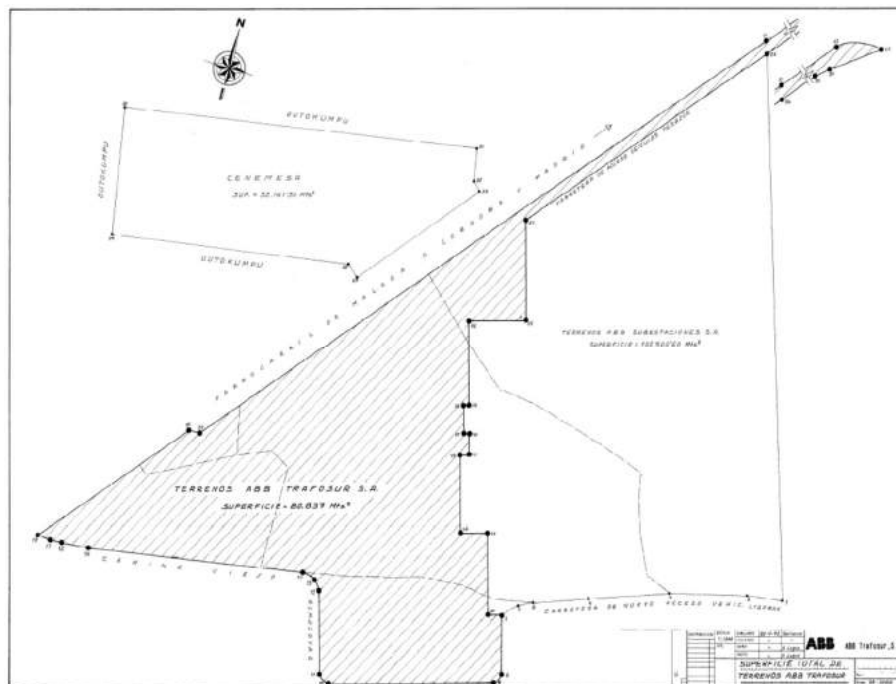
Planos catastral elaboración propiedad ABB.
